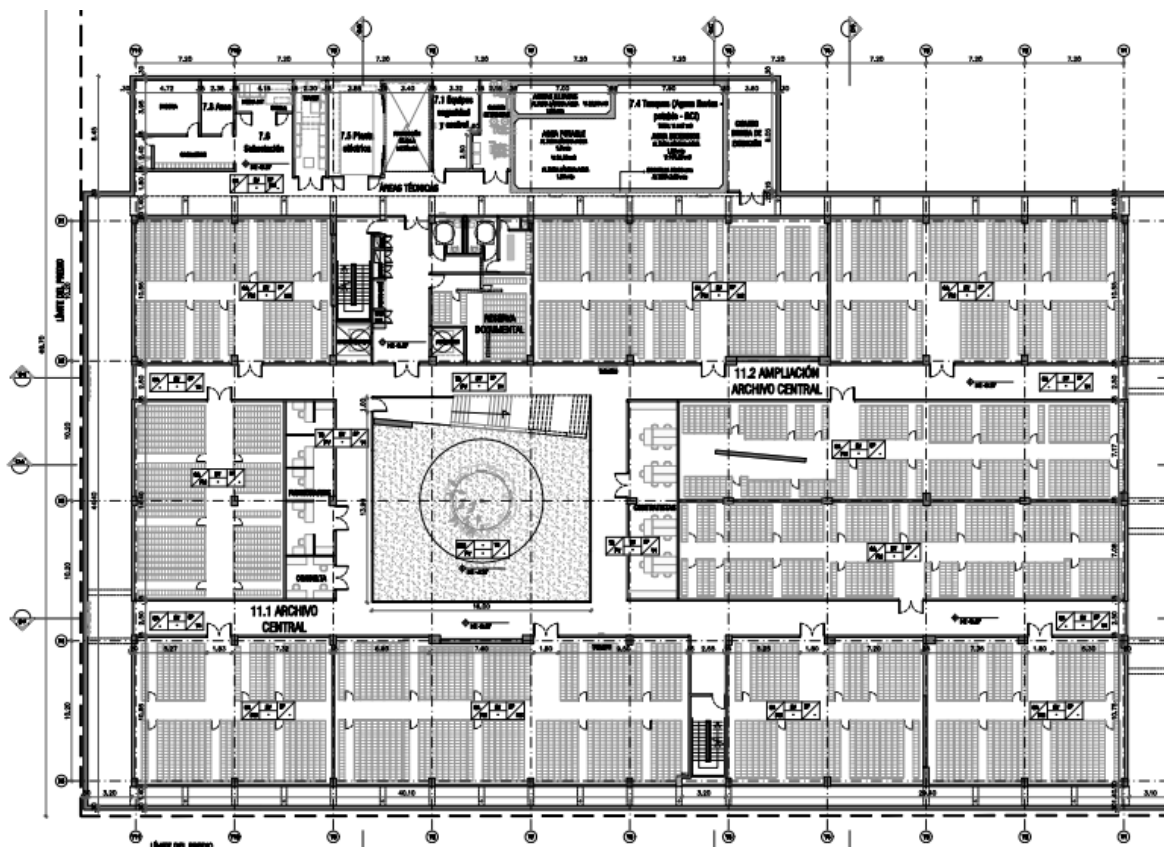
Planta sótano. Fuente: Planos arquitectónicos.
